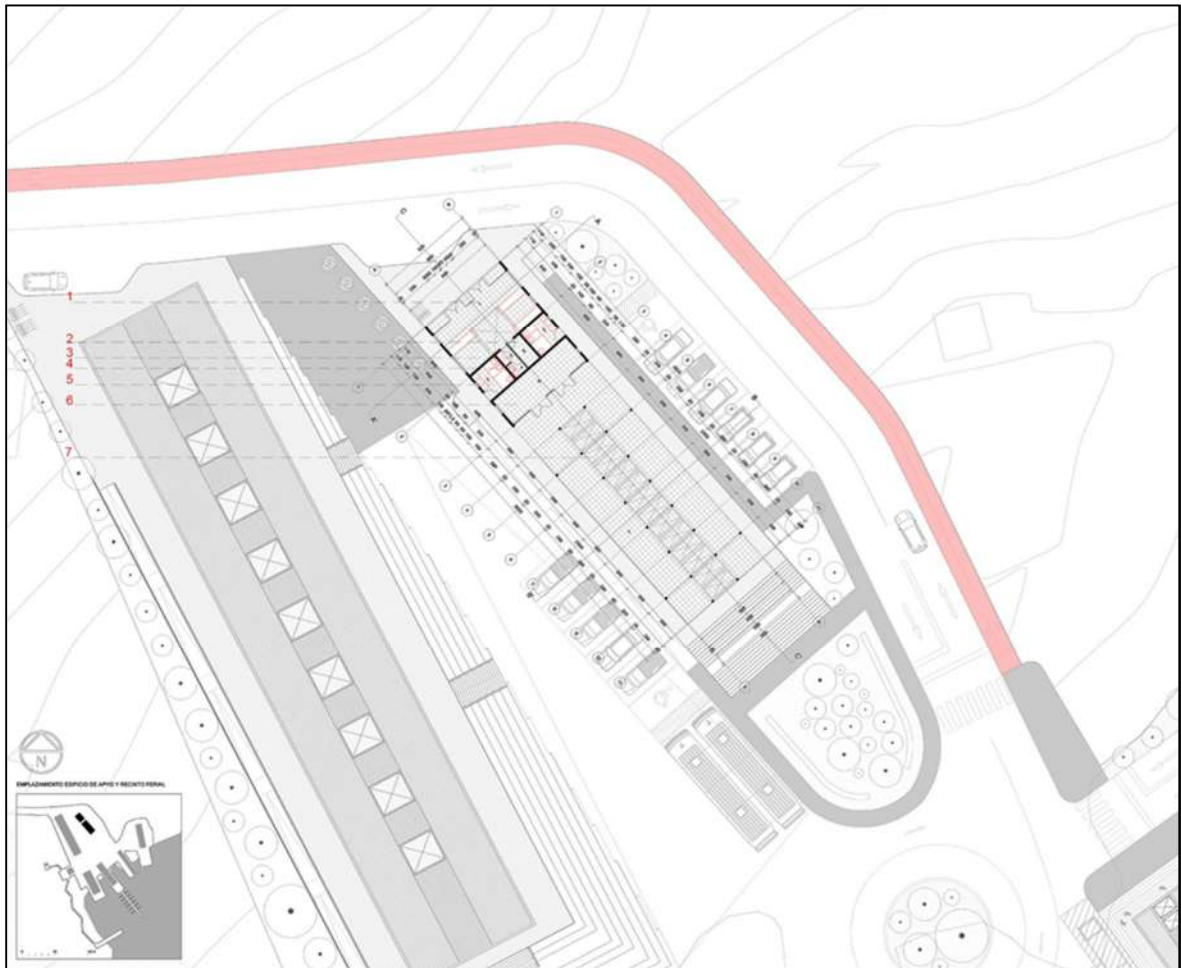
PLANTA EDIFICIO DE APOYO Y RECINTO FERIAL
